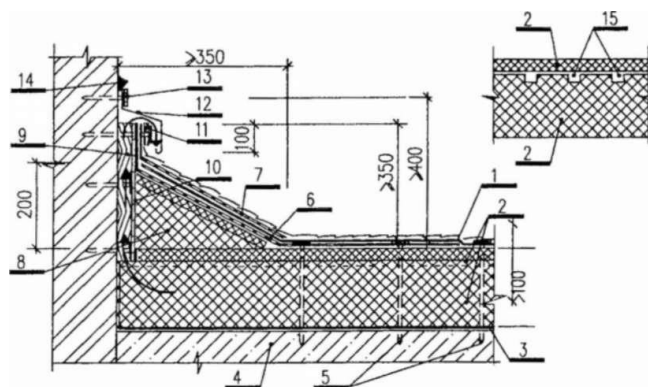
Примыкание однослойной кровли с жестким минераловатным утеплителем с самовентиляцией кровли через примыкание
